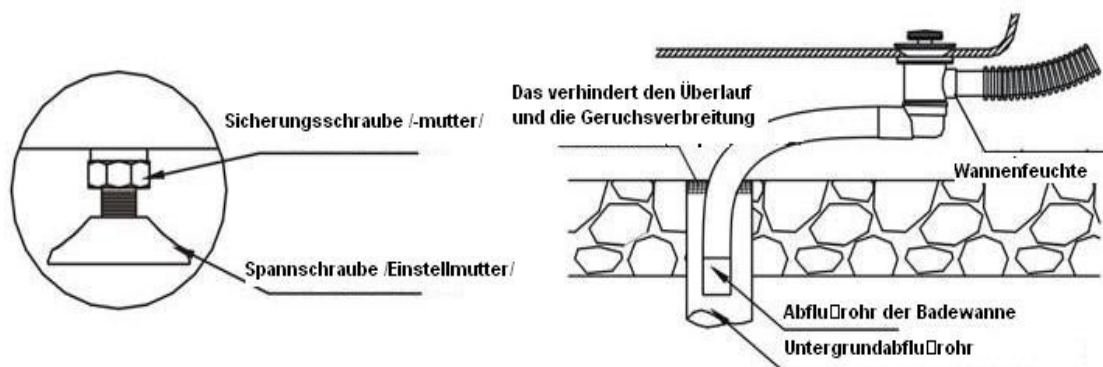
Die Einstellung der Ständerschraube Bild 2 Die Abdichtung der Wasserrohre
